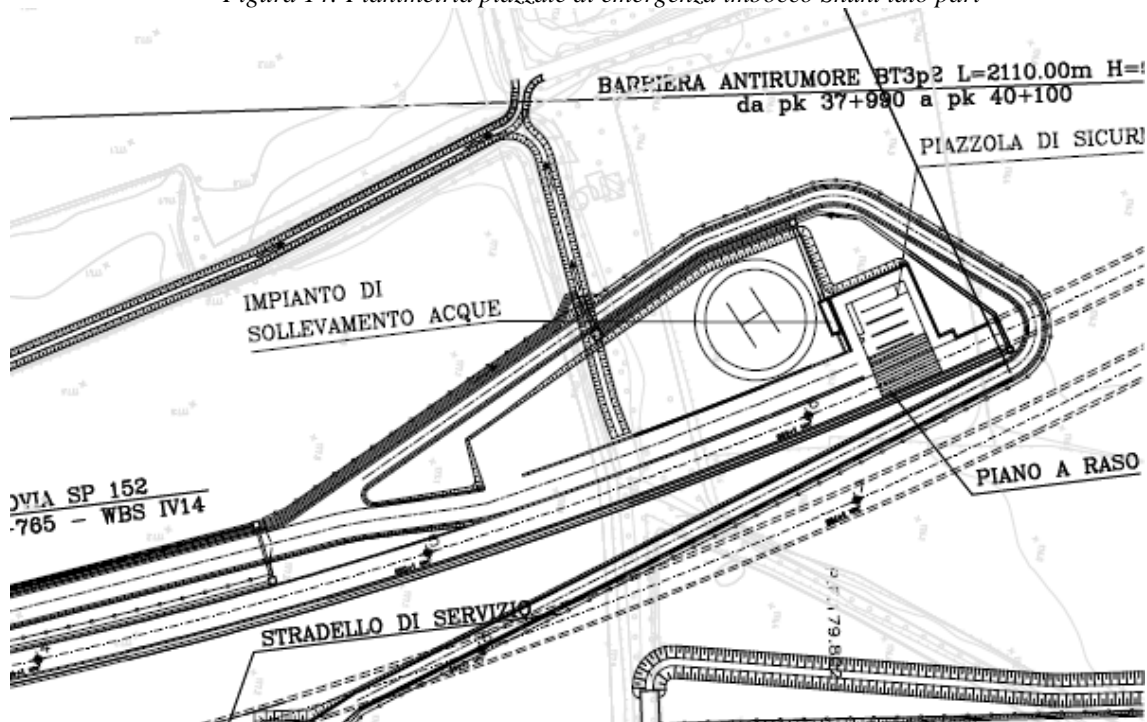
Planimetria piazzale di emergenza imbocco Shunt sud lato dispari
